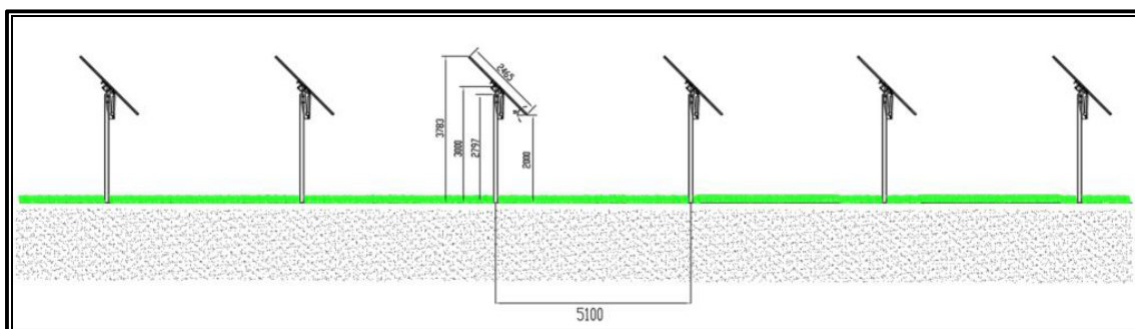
Particolare strutture ad inseguimento Tracker tipo 1P
